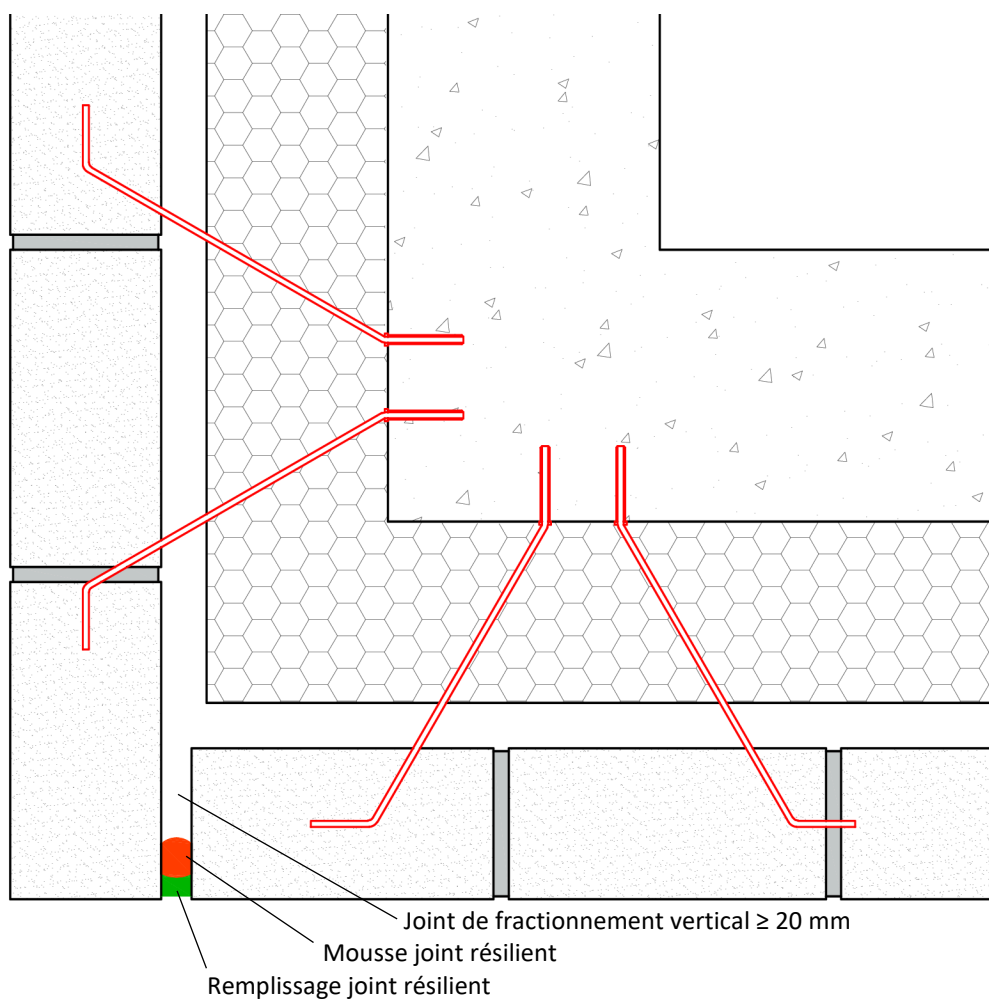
Joint de fractionnement vertical - coupe franche (coupe)
